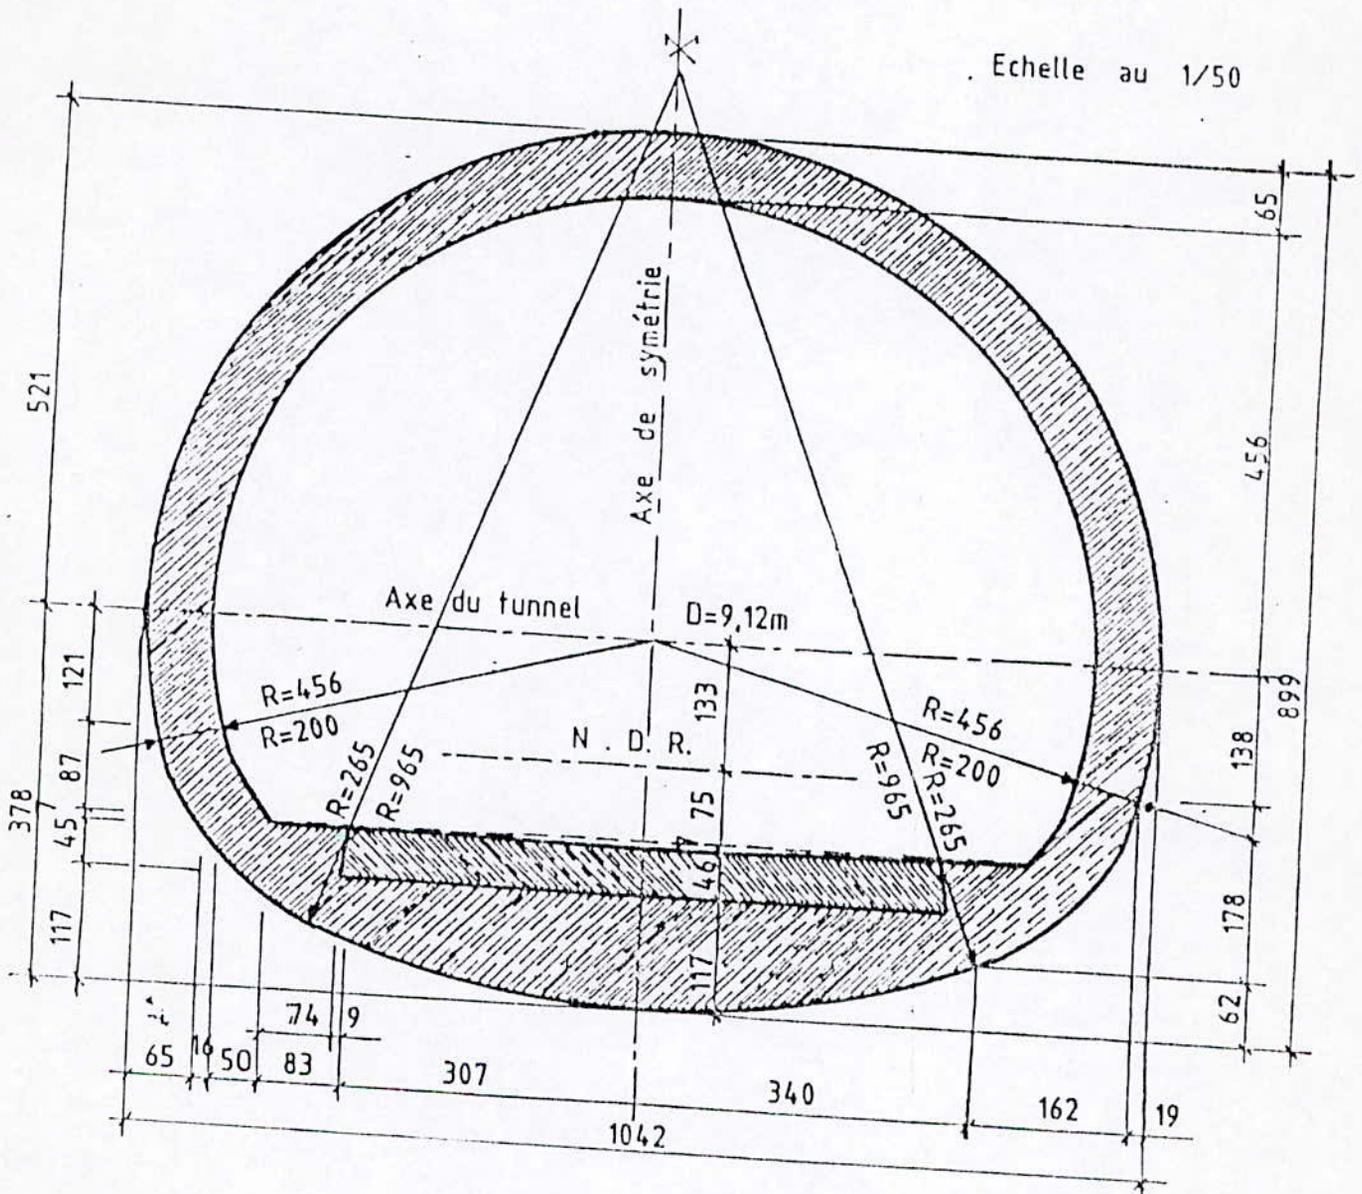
COUPE TYPE SUR LE REVETEMENT DU TUNNEL
